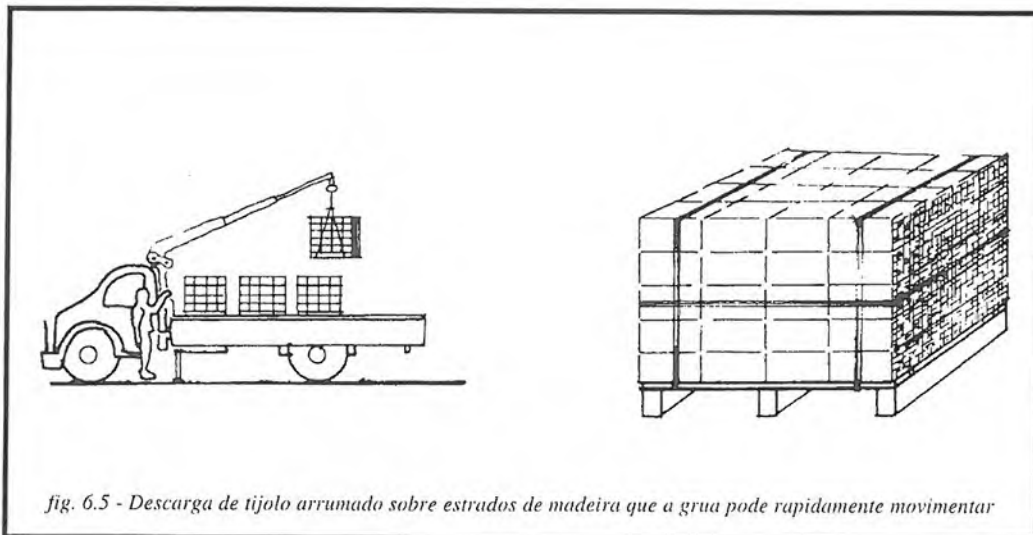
Descarga de tijolo arrumado sobre estrados de madeira que a grua pode rapidamente movimentar
